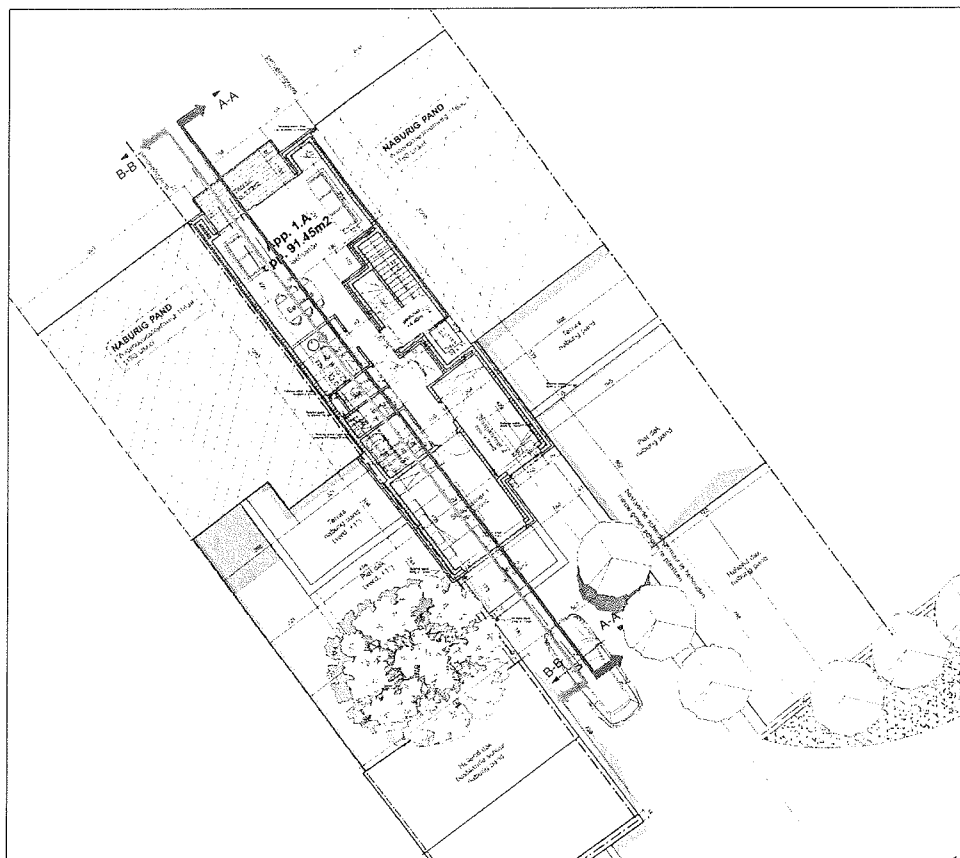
Niveau +1 de la maison située à front de la chaussée de Waterloo
